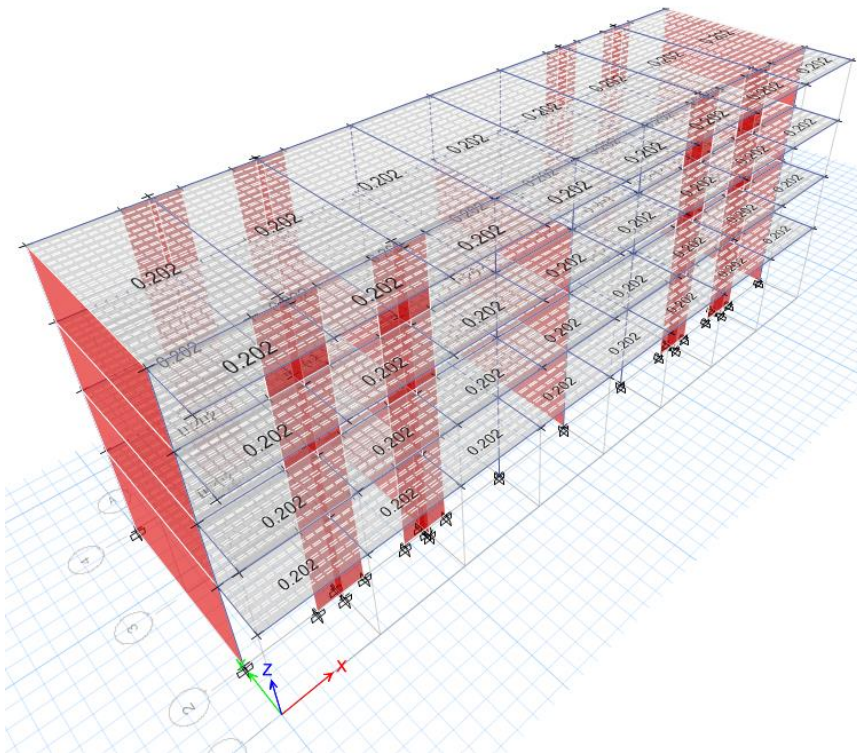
Vista general de las cargas Muertas asignadas a las viguetas
